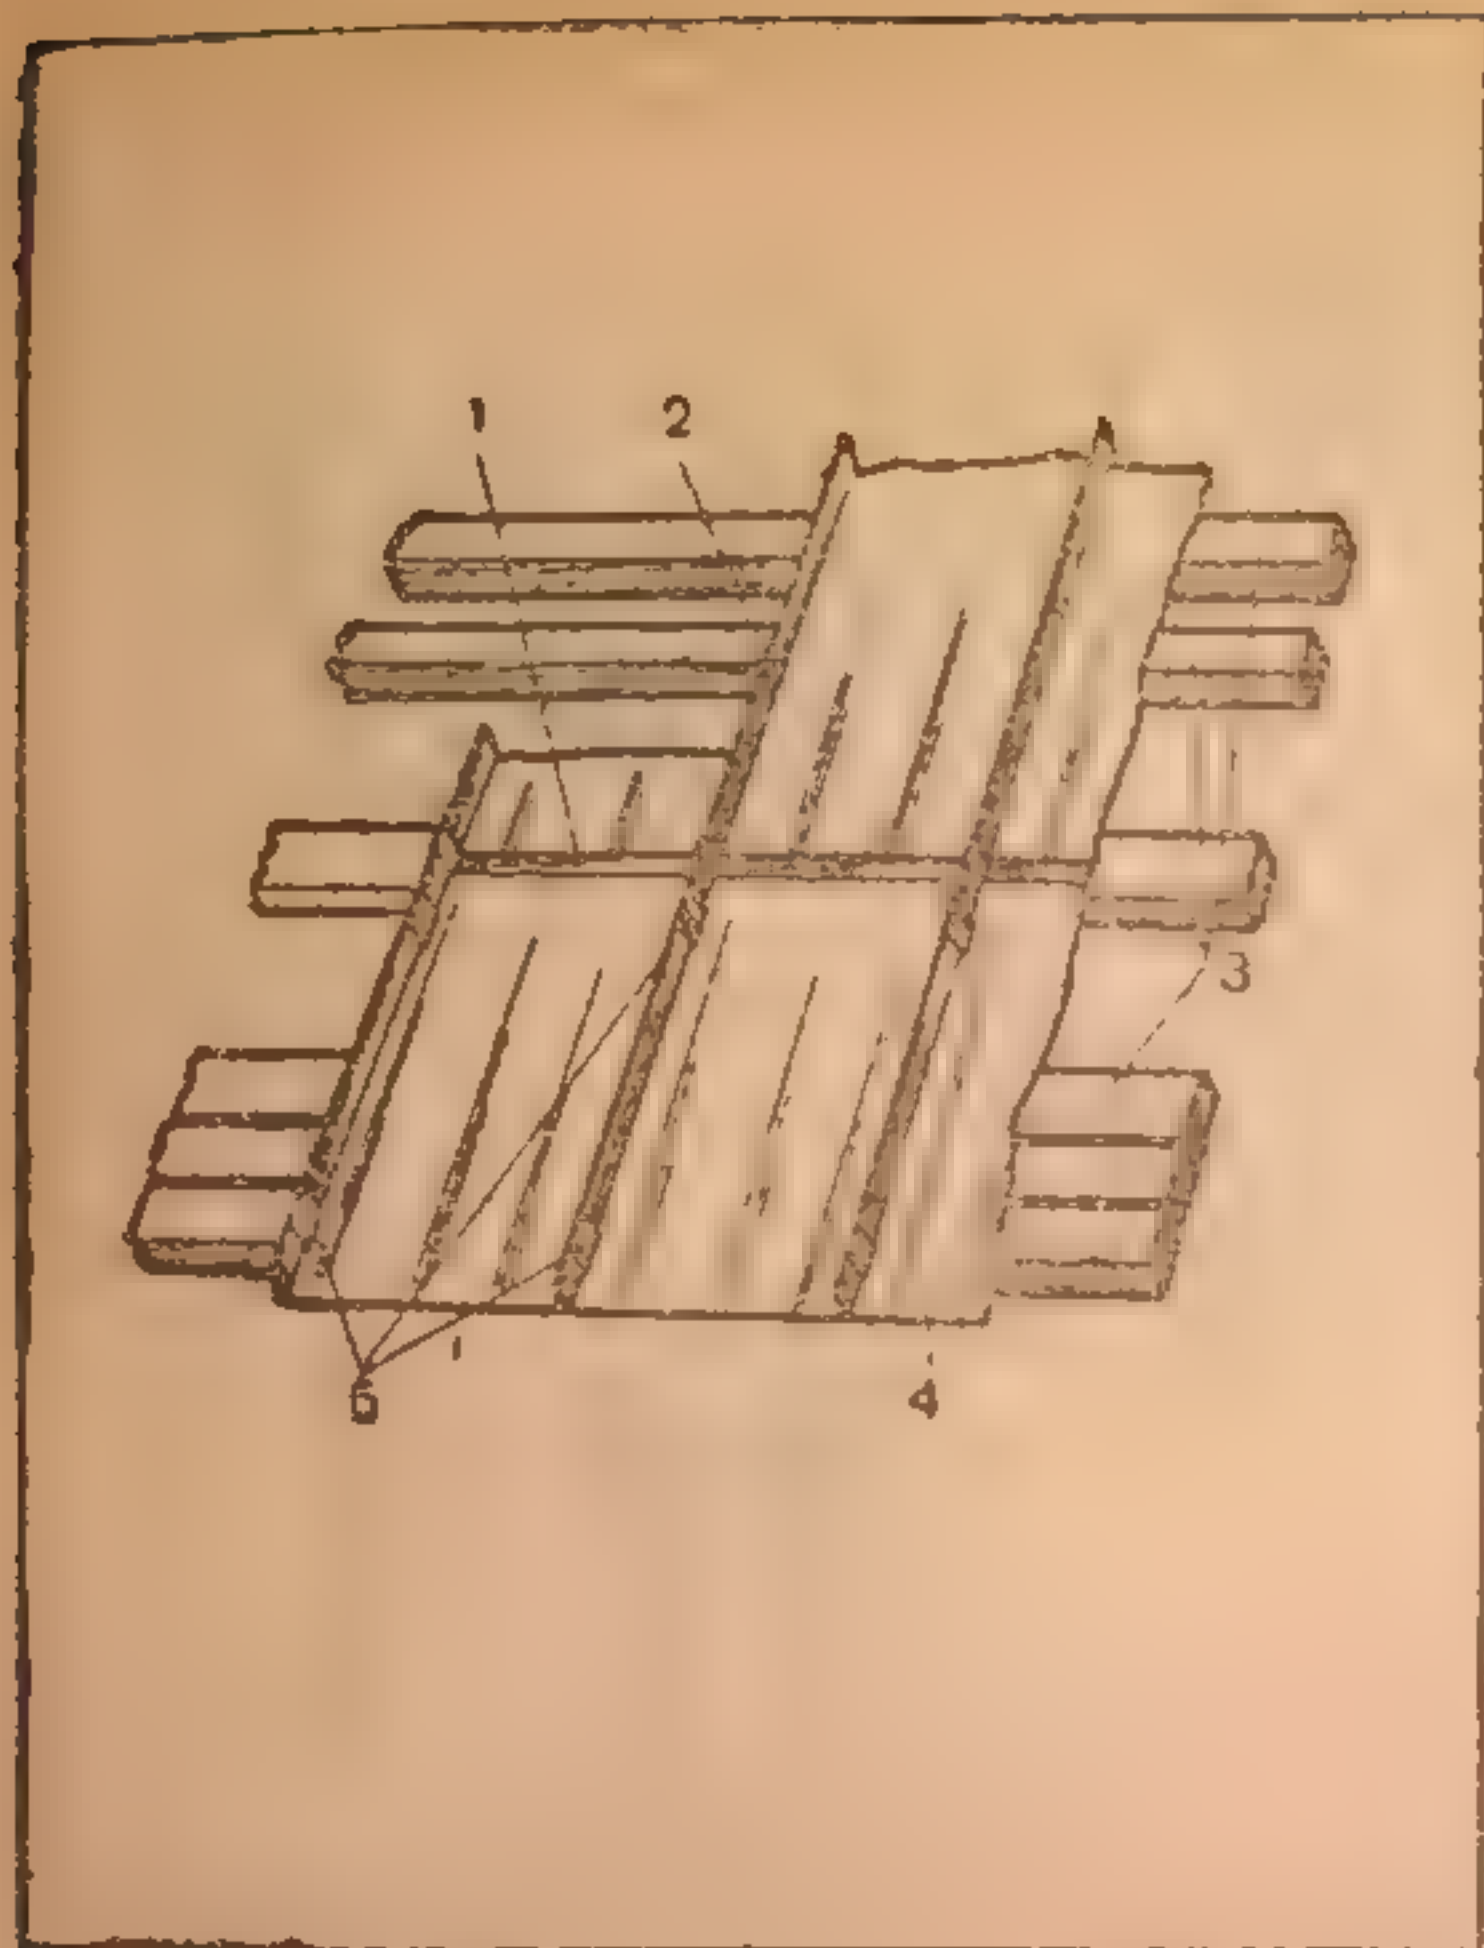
Расположение рядов кровли при рядовом покрытии:
